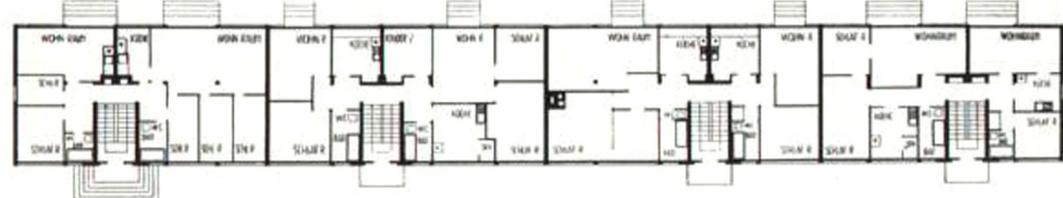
Haus Mies Van der Rohe, Grundriss EG-DG
